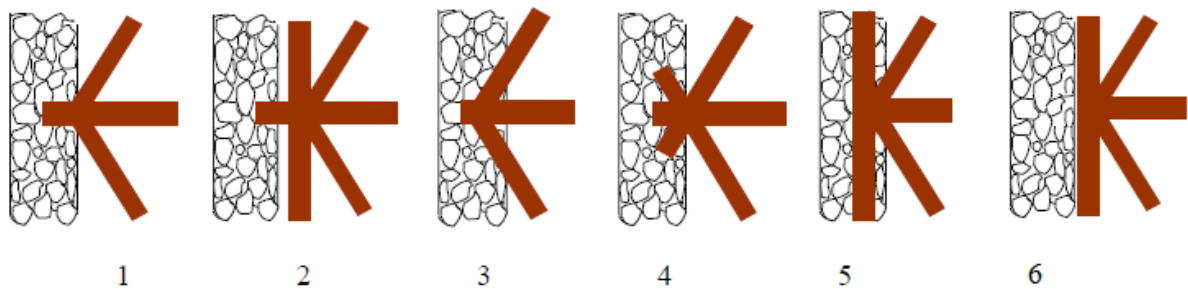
Exemplos de ligação entre parede em frontal e parede de alvenaria (adaptado de (Cardoso, 2002)).
